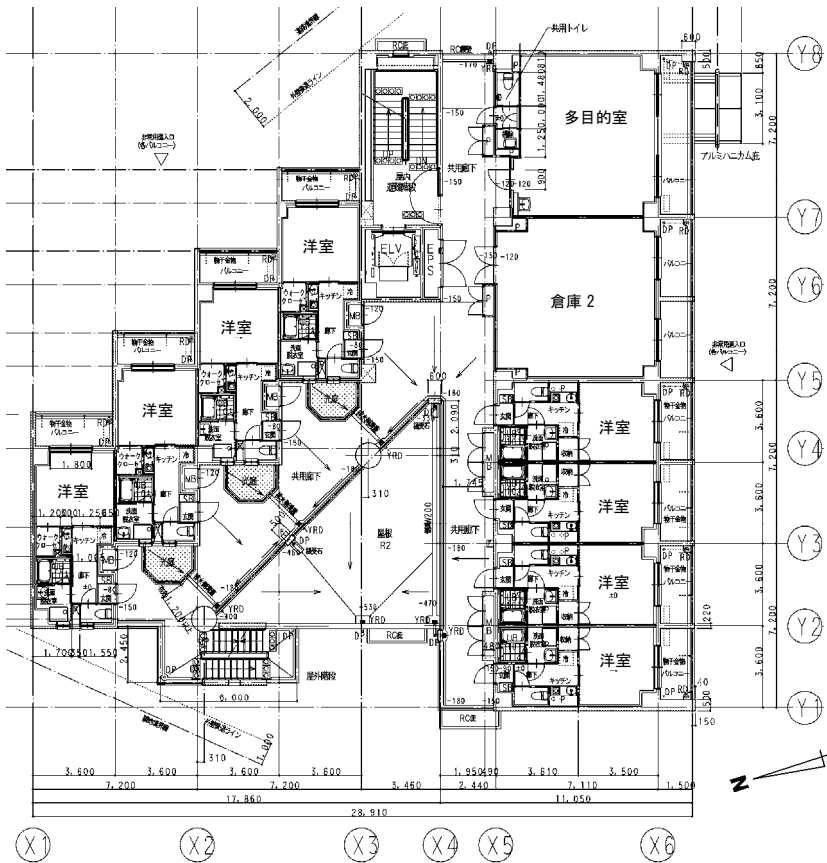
研修医宿舎棟建築平面図 (3階)
